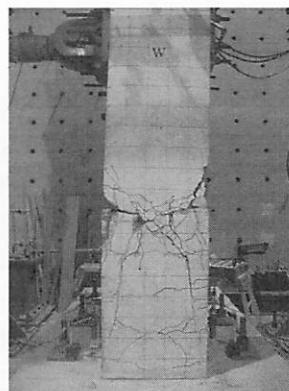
No. 1 供試体の損傷状況 (7δ 載荷終了時)
